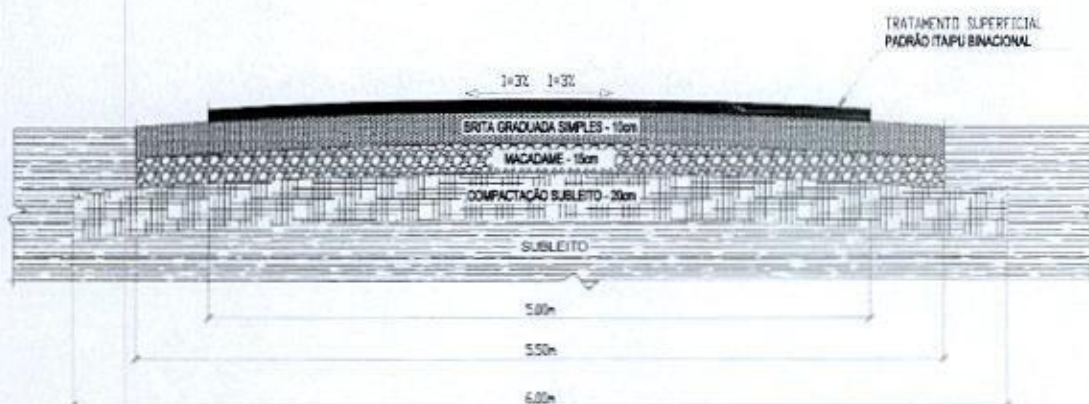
Exemplificação da declividade, base e sub-base e espessura e largura das camadas do pavimento.
